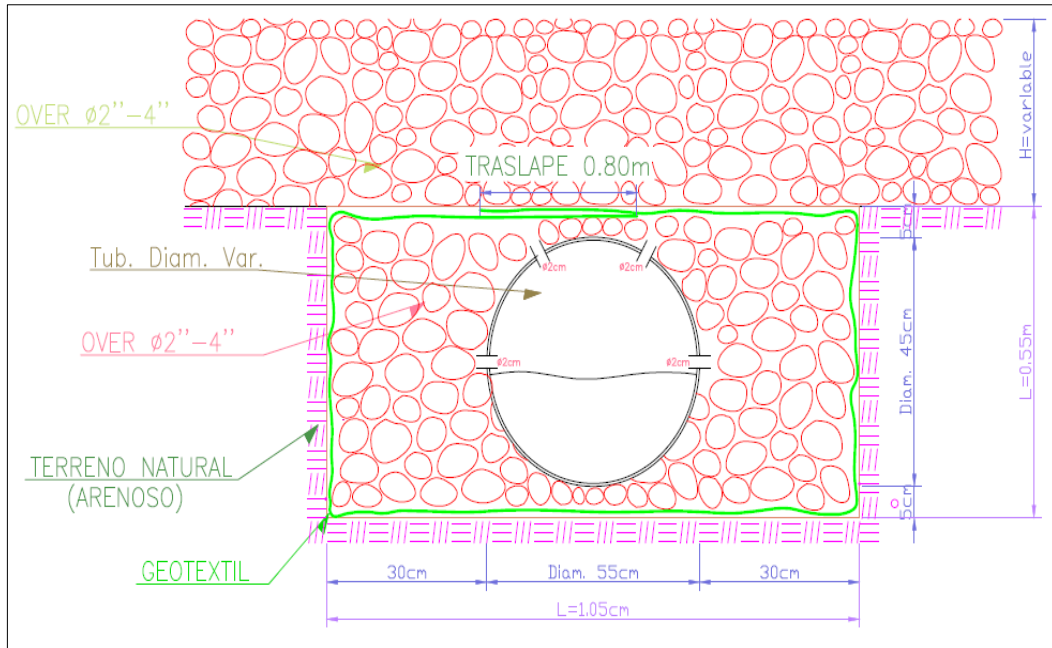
Sección Transversal de Dren-Corte-Geotextil
